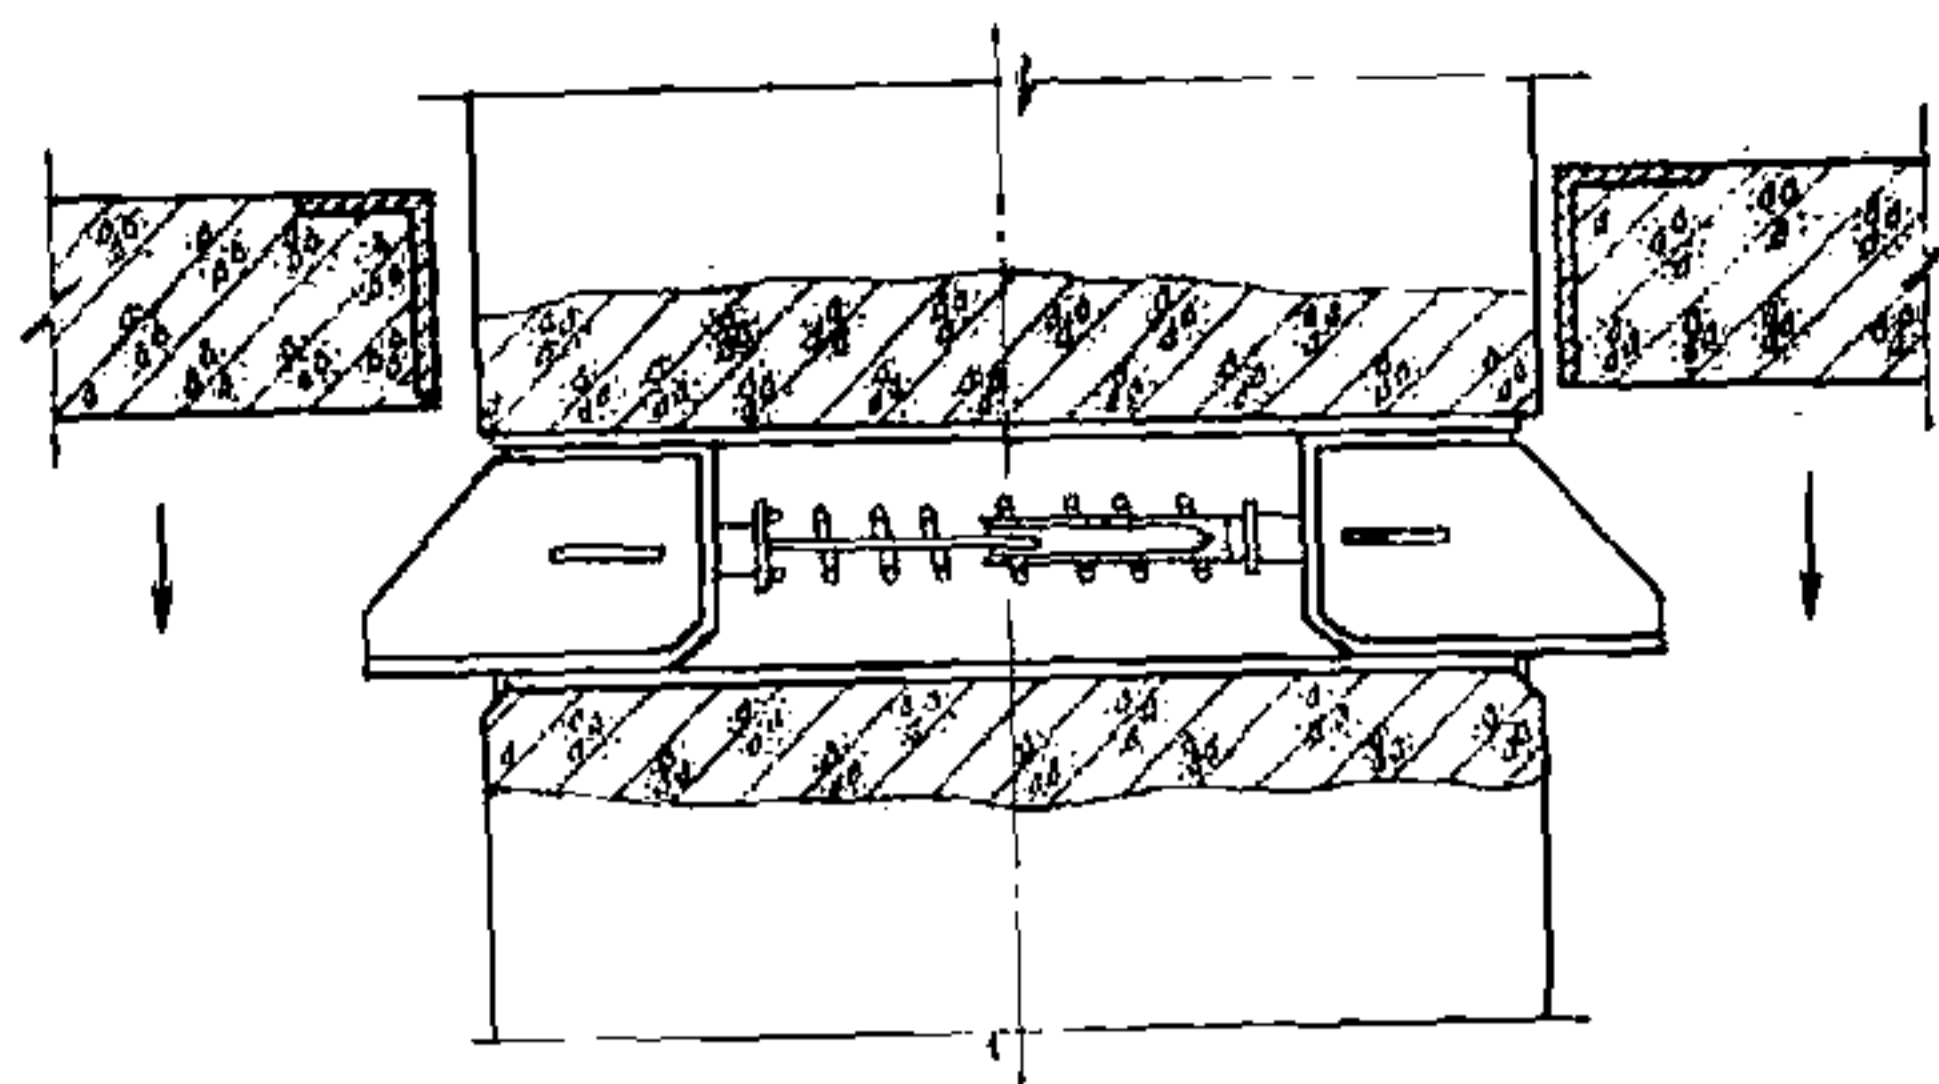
Конструкция пружинной защелки (ЛенЗНИИЭП) для временного опирания перекрытия на колонну
